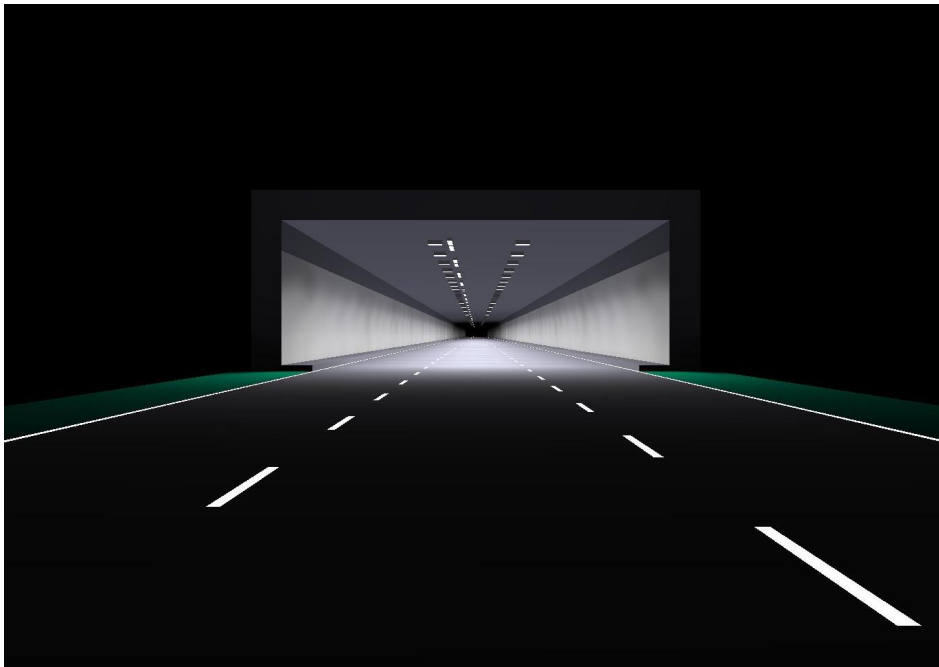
Lichtraumprofil 3-streifiger Tunnel
